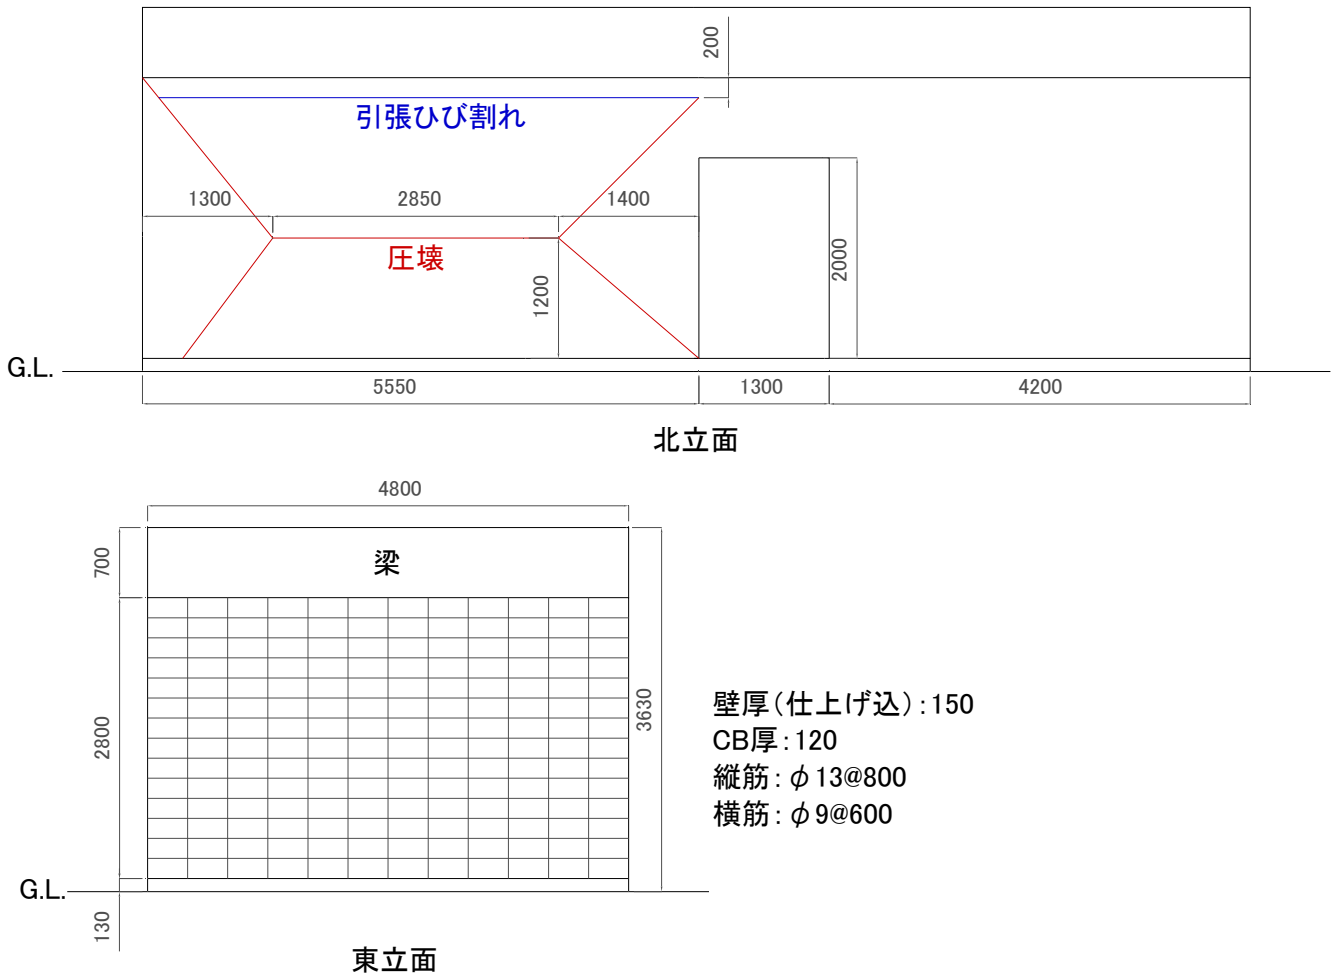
CB造平屋冷凍庫の立面図 (単位: mm)
